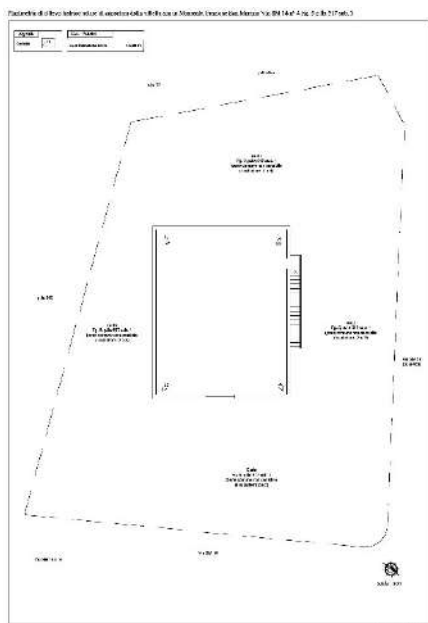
(Allegato 9) Lastrico solare di 1° piano – Fig. 5, p.lla 517, sub.3
